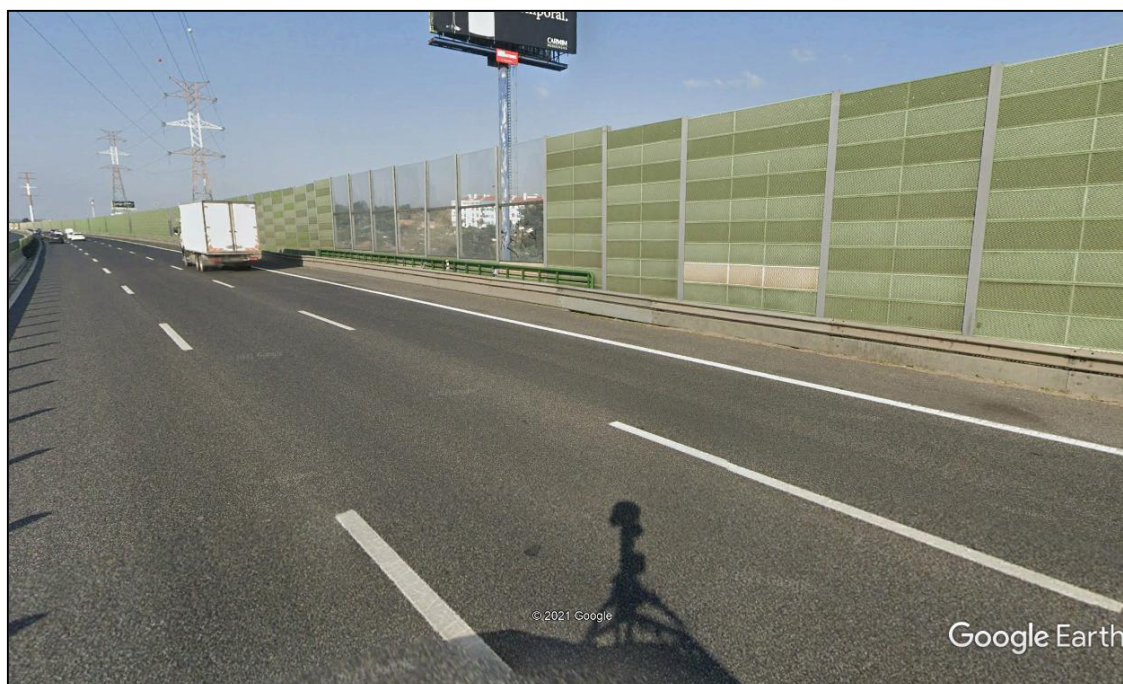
Exemplos de barreiras acústicas instaladas na A1
